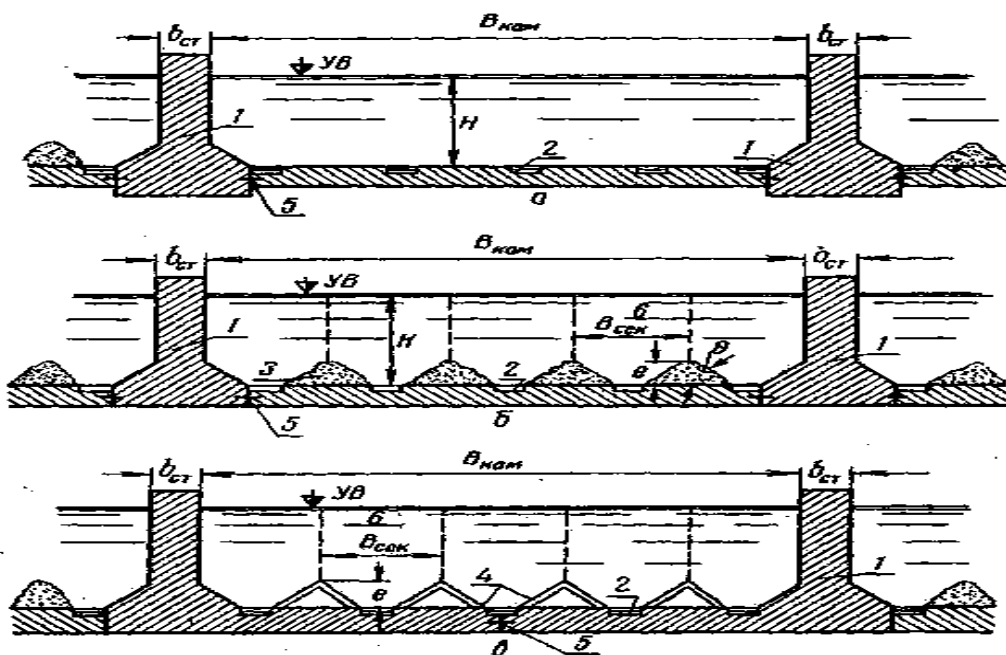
Поперечное сечение камер отстойника с непрерывной промывкой:
